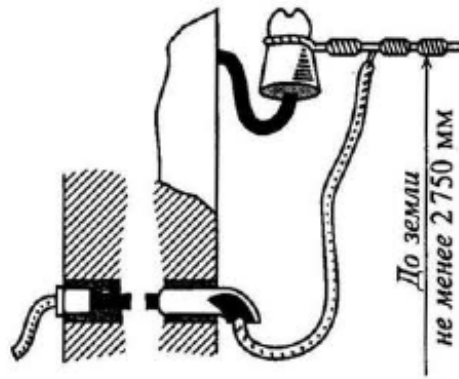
Устройство ввода в здание от ВЛ напряжением до 1 кВ
